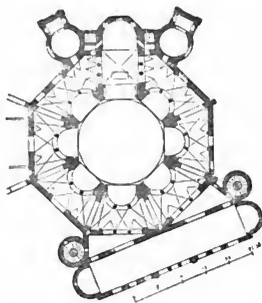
S. Vitale in Ravenna. Grundriss.
